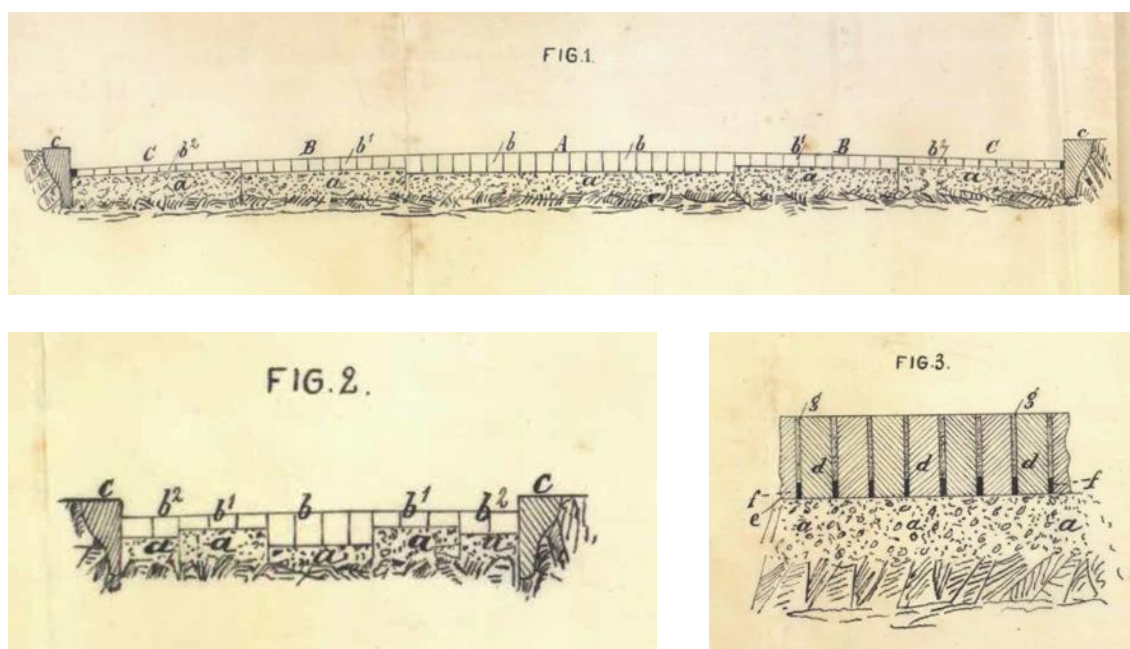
> Sistema Descole para la construcción de adoquines sobre base de hormigón escalonada. 1. Corte transversal; 2. Sección de una vía estrecha; 3. Detalle corte longitudinal (Descole 1885. En AMCB 1885)
